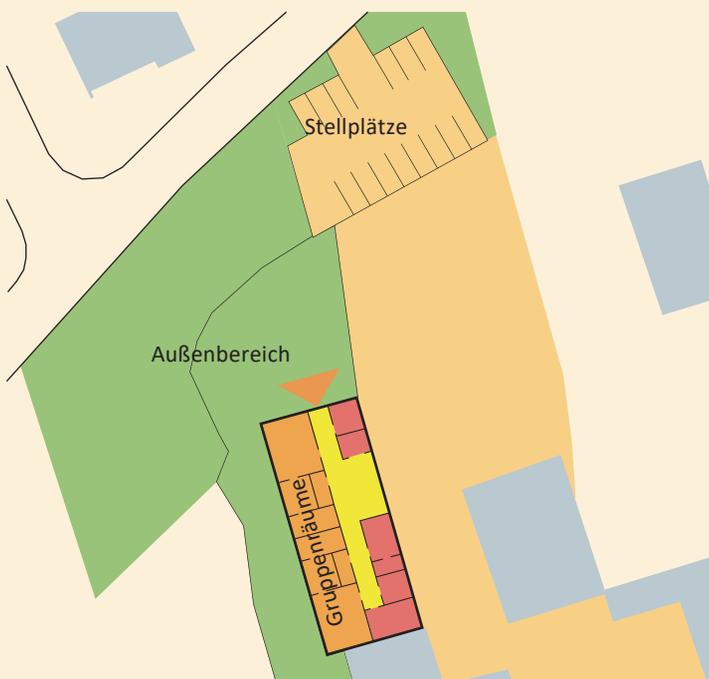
Grundrisse und Perspektive Kindertagesstätte (Architekturbüro Schwirzer)
